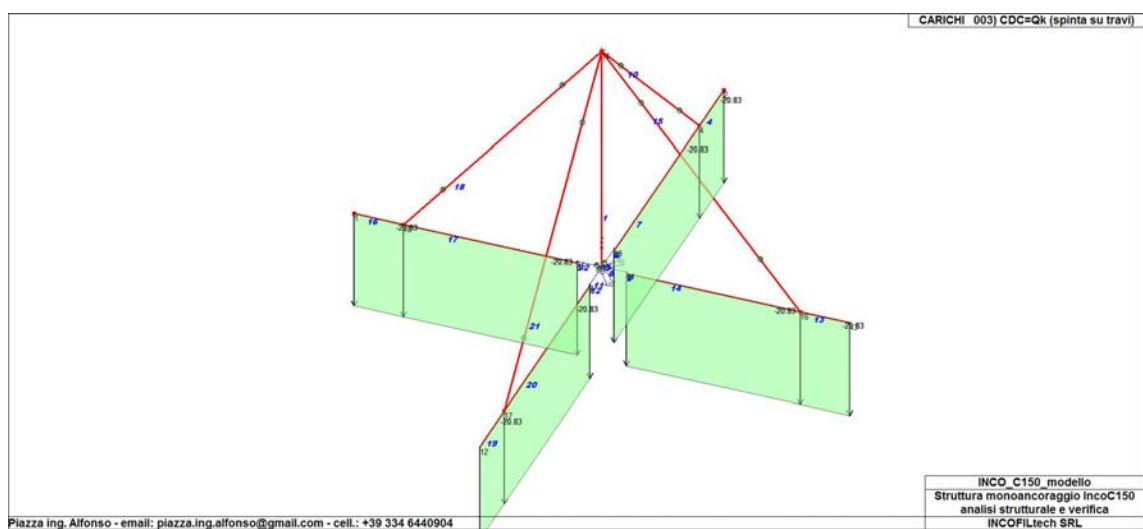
Condizione di carico: Qk2 (spinta su travi)
